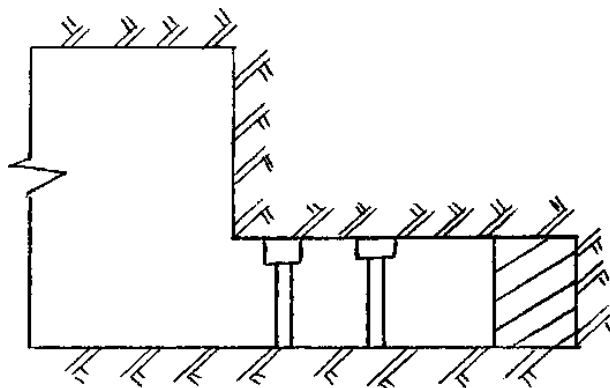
Технологическая схема проведения штреков узким забоем с верхней подрывкой и раздельной выемкой угля и породы при совмещении этих работ во времени
